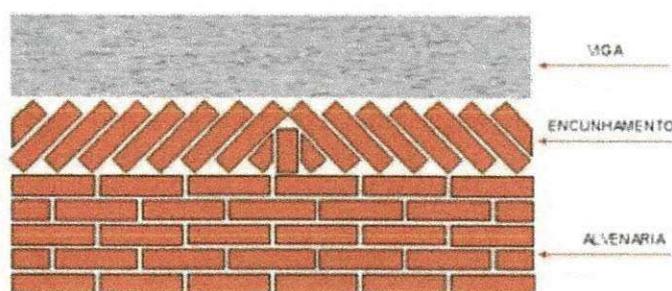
Aperto da alvenaria com tijolo maciço (encunhamento). Fonte: [www.forumdaconstrucao.com.br](http://www.forumdaconstrucao.com.br)
